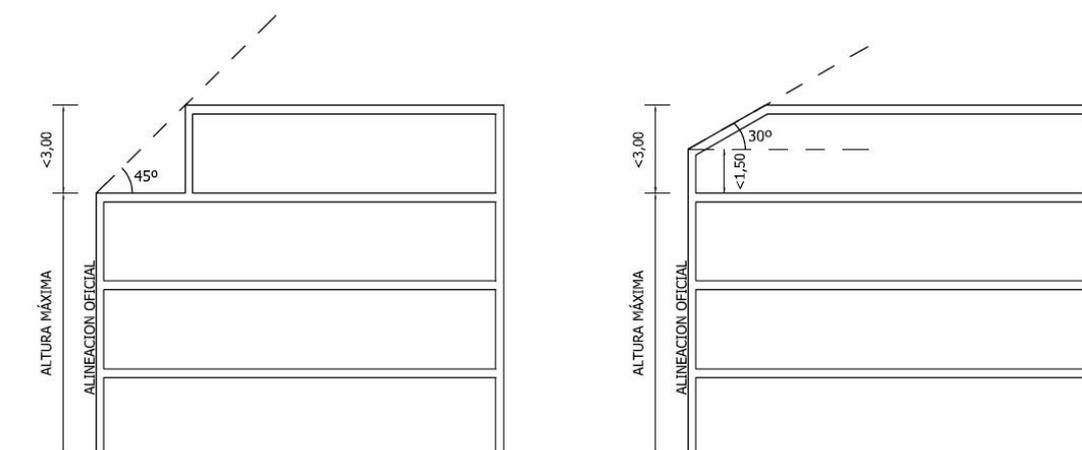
Construcciones por encima de la altura máxima: áticos (izquierda) y cámaras (derecha)
